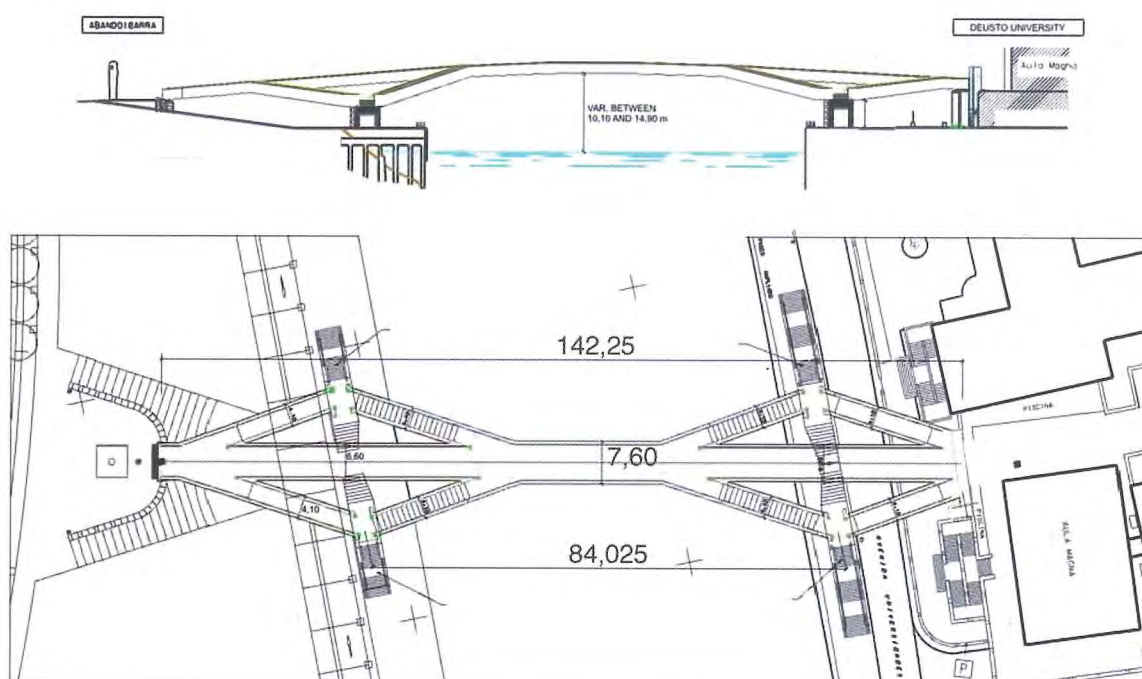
Elévation et vue en plan de la passerelle / Front and plan view of the footbridge
